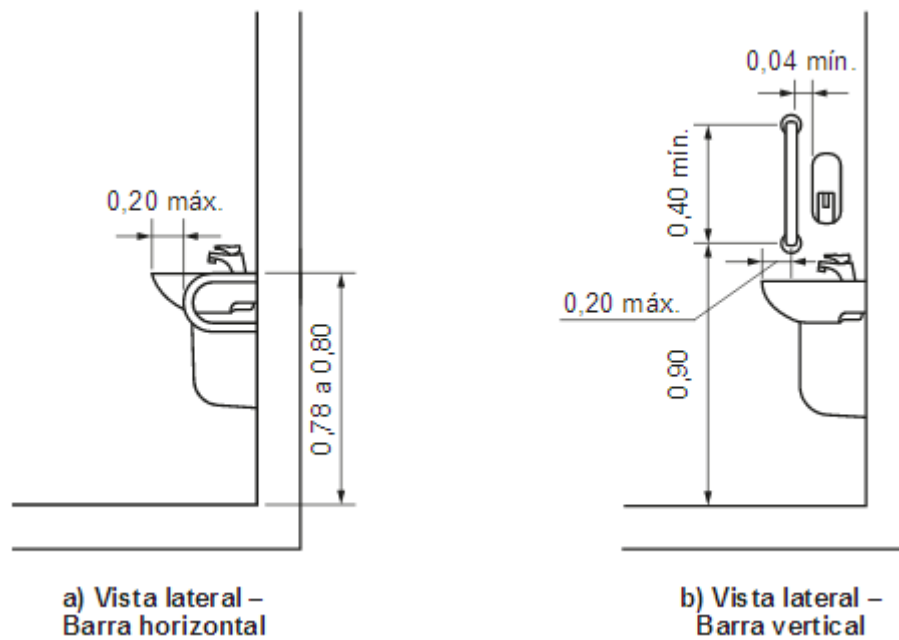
Barra de apoio no lavatório – vista lateral (metros)
